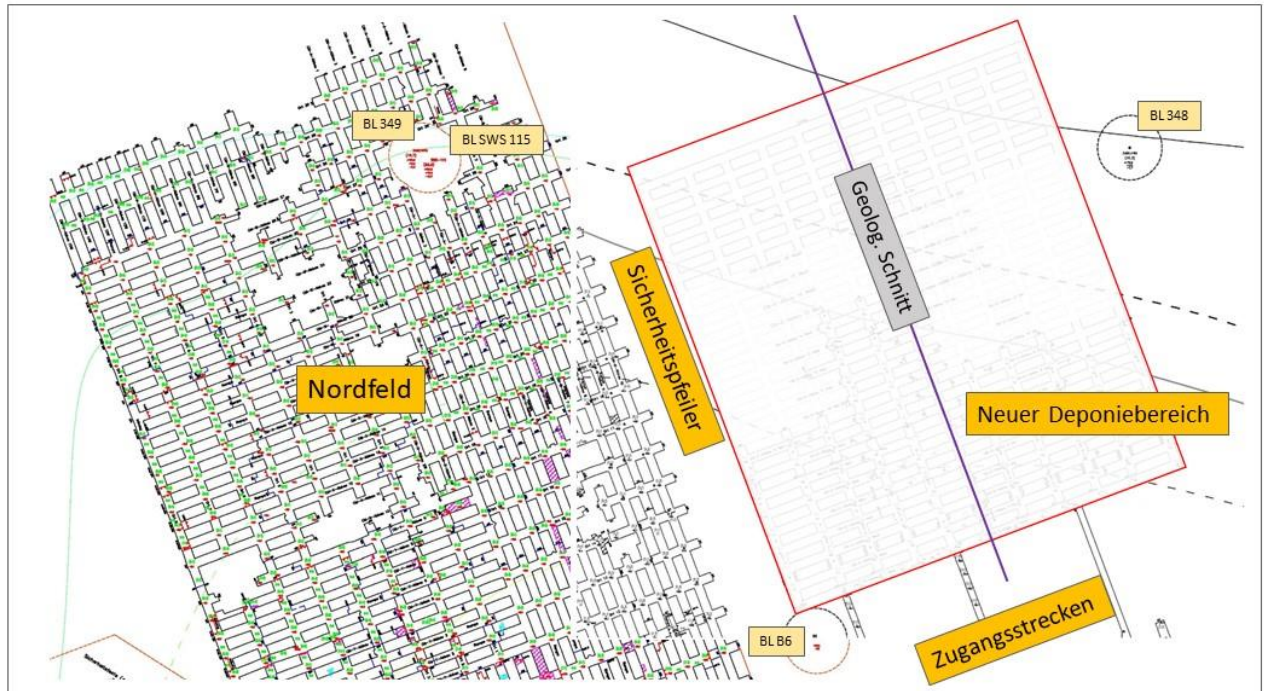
Lageplan und Grundriss des neuen Deponiebereiches.
